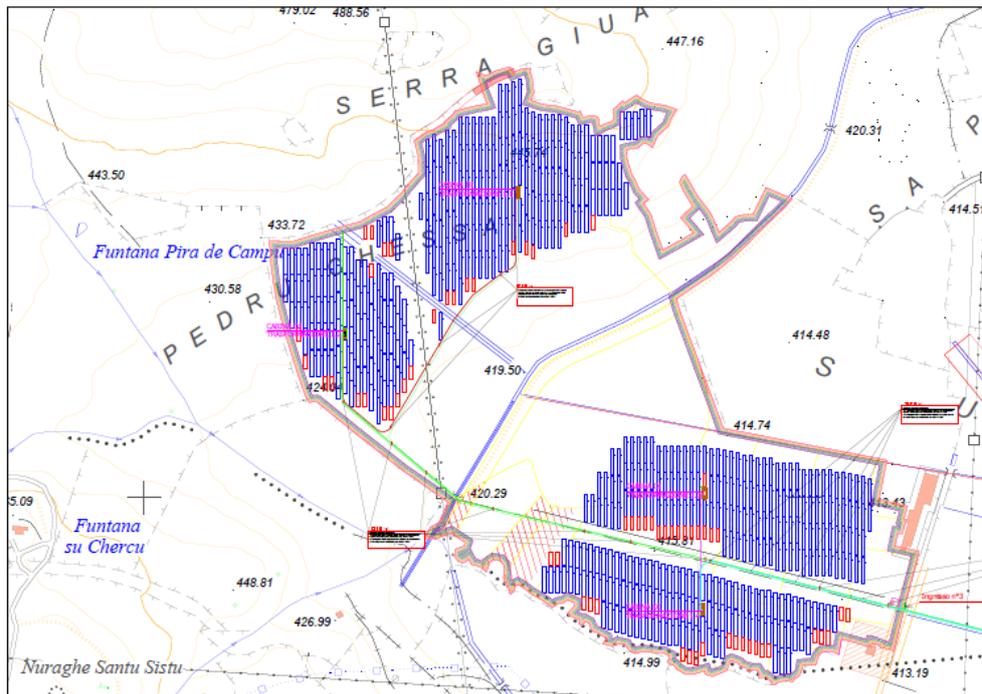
Campo C1: disposizione moduli con rispetto della fascia di 150 m
